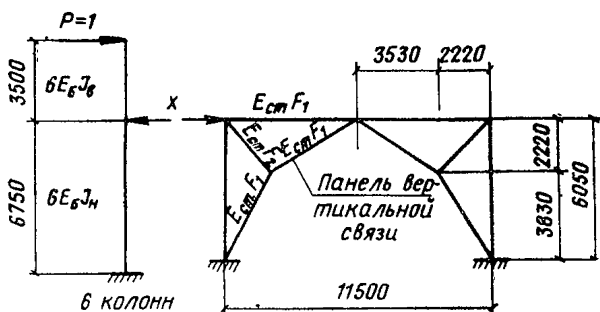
Расчетная схема среднего продольного ряда колонн каркаса
